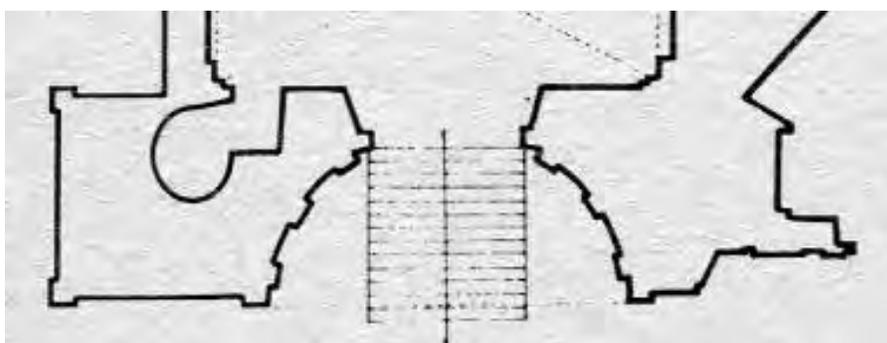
y 25.- Planta Arquitectónica de la fachada del Santuario de Guadalupe, Ciudad de México (izquierda). Planta arquitectónica de la fachada del templo de San Juan de Dios, Ciudad de México (derecha).
